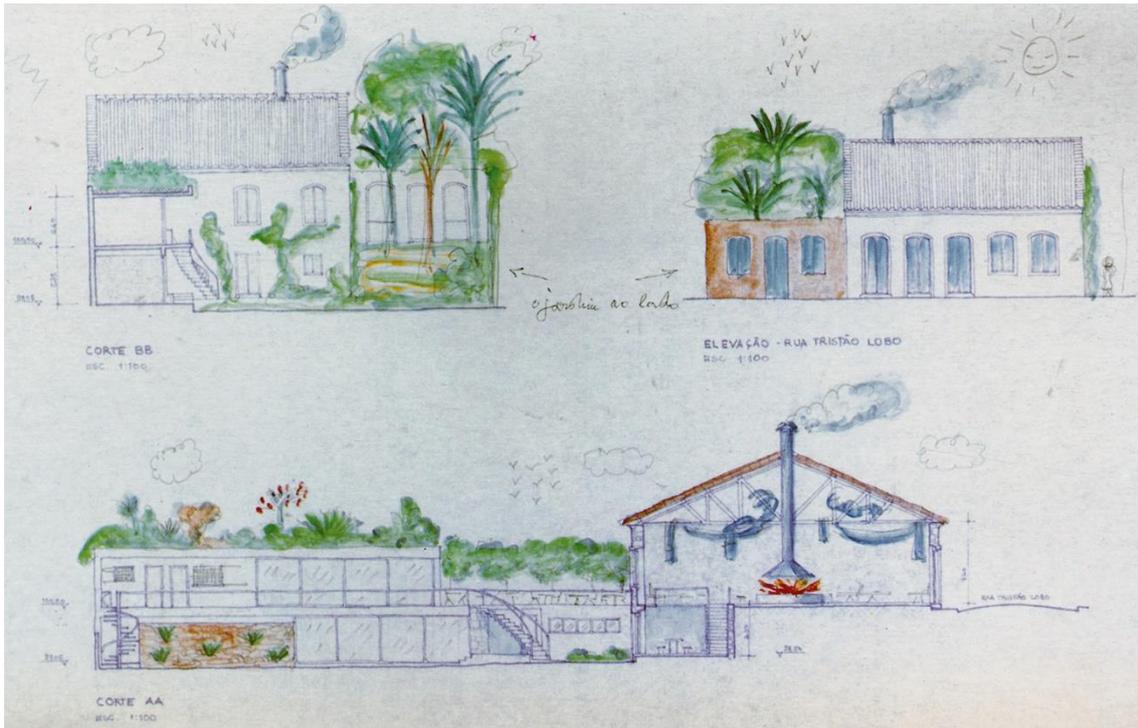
planos del Centro de Convivencia LBA, Lina Bo Bardi, archivo Instituto Bardi
